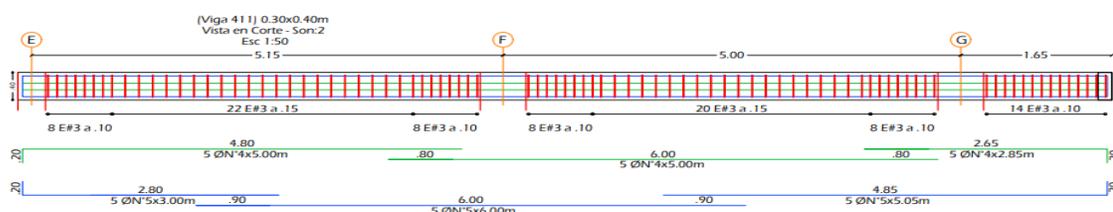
Despiece de viga principal 411 plano estructural Wiedii
